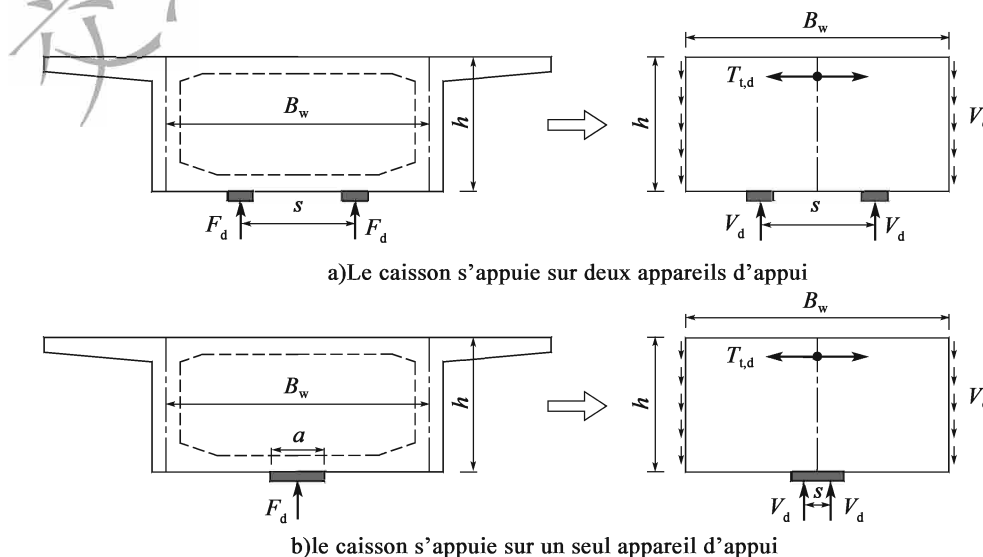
Calcul de l'effort de traction en haut de l'entretoise au niveau de la section sur appui
